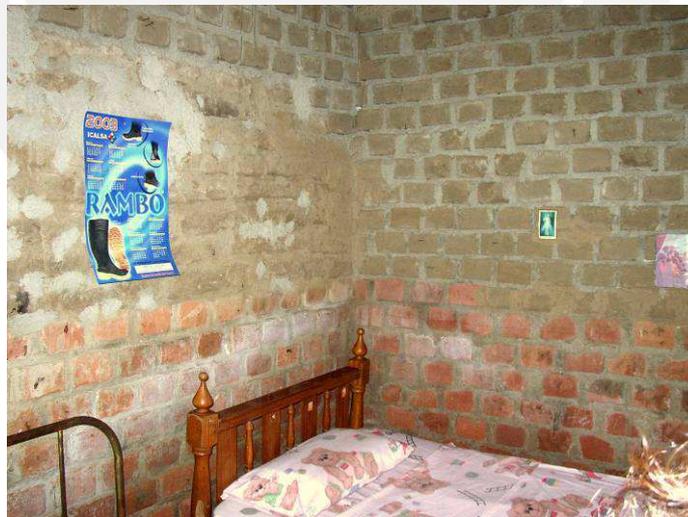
Tabiques completados con ladrillo crudo asentado con barro y mortero
